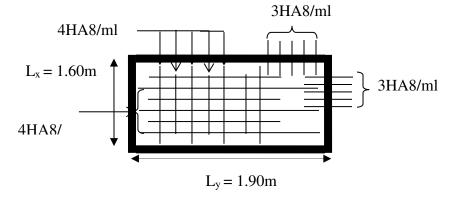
Schéma de ferraillage de la dalle du locale des machines.
